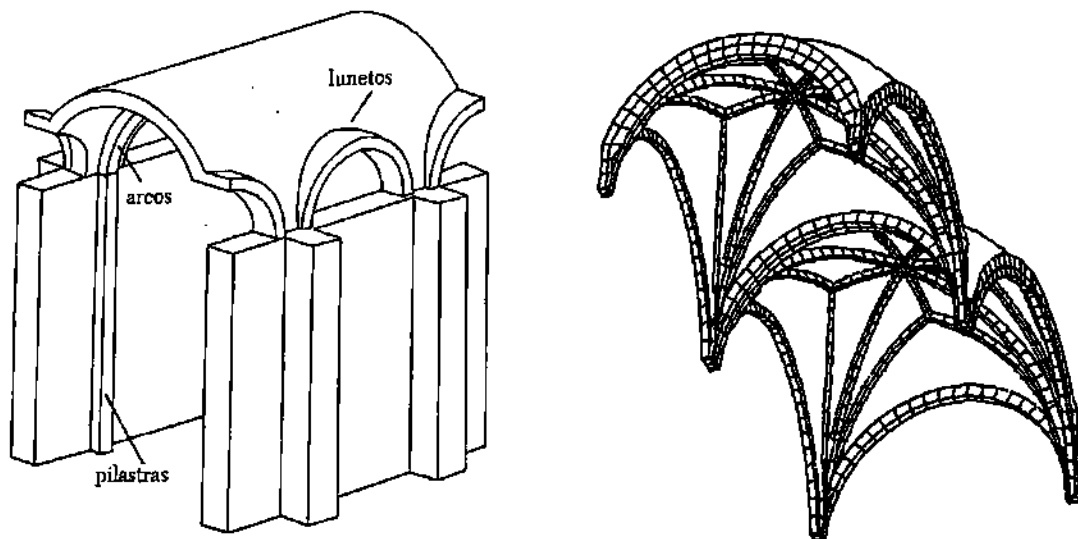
b. Izquierda nave con lunetos, derecha nave nervadas. (Los conventos mexicanos del siglo XVI: construcción, ingeniería estructural y conservación; autor: Roberto Meli Piralla.)
